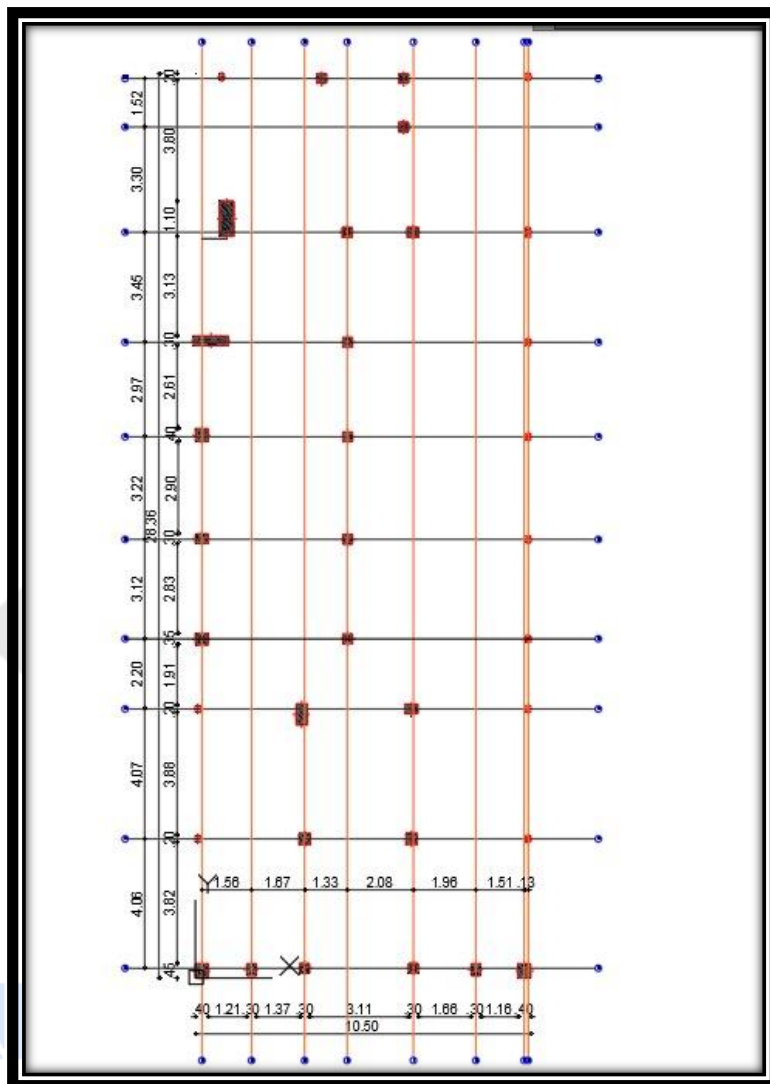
Ubicación de Columnas primer piso. Fuente. Esta consultoría
